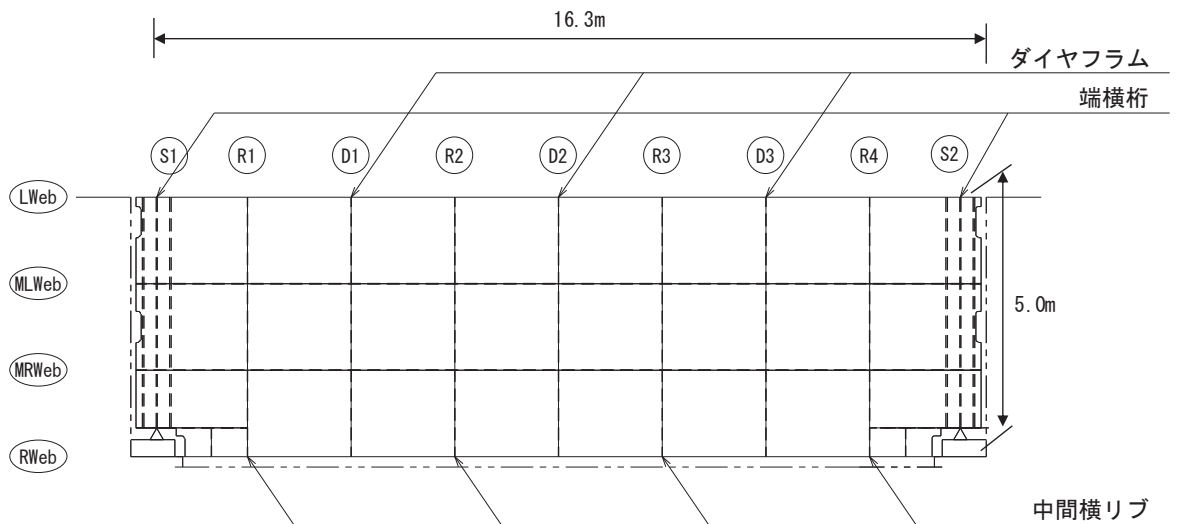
(2) 鋼製遮水壁 (鋼桁 6) 平面図
